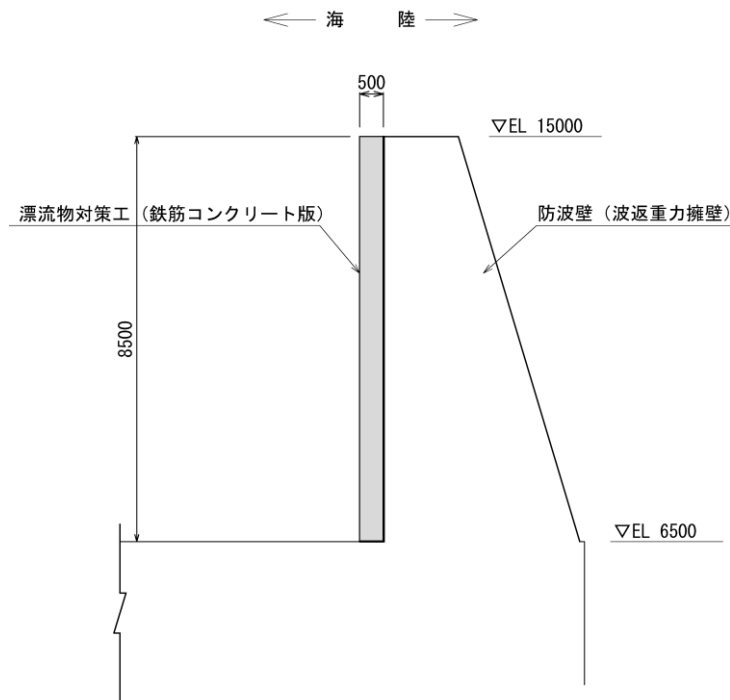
(2) 防波壁 (波返重力擁壁) 重力擁壁における漂流物対策工 (鉄筋コンクリート版) の構造概要図 (標準断面図)
